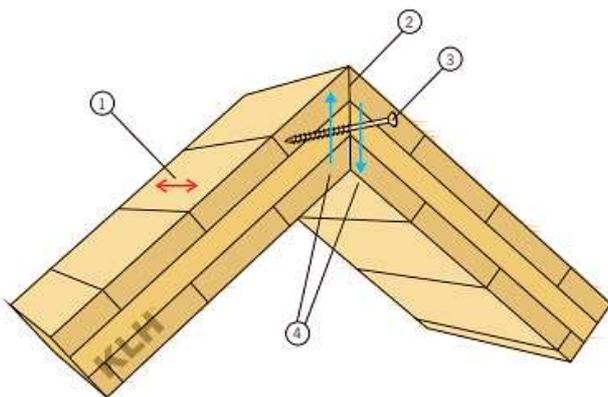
Ligação entre painéis de laje (parafusos roscados) [24]
